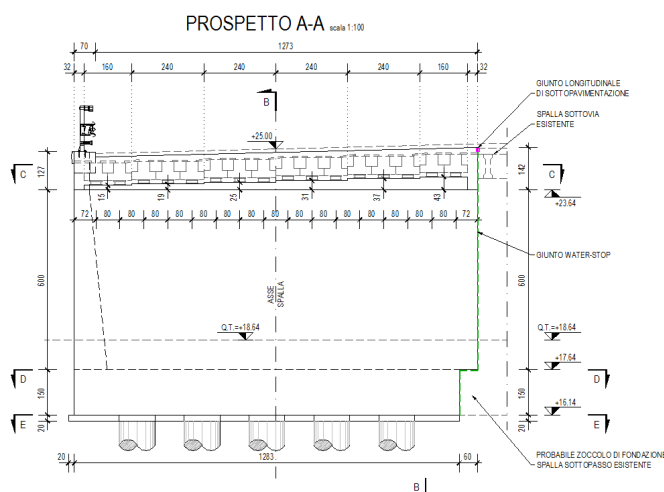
Prospetto spalla 1 impalcato est
